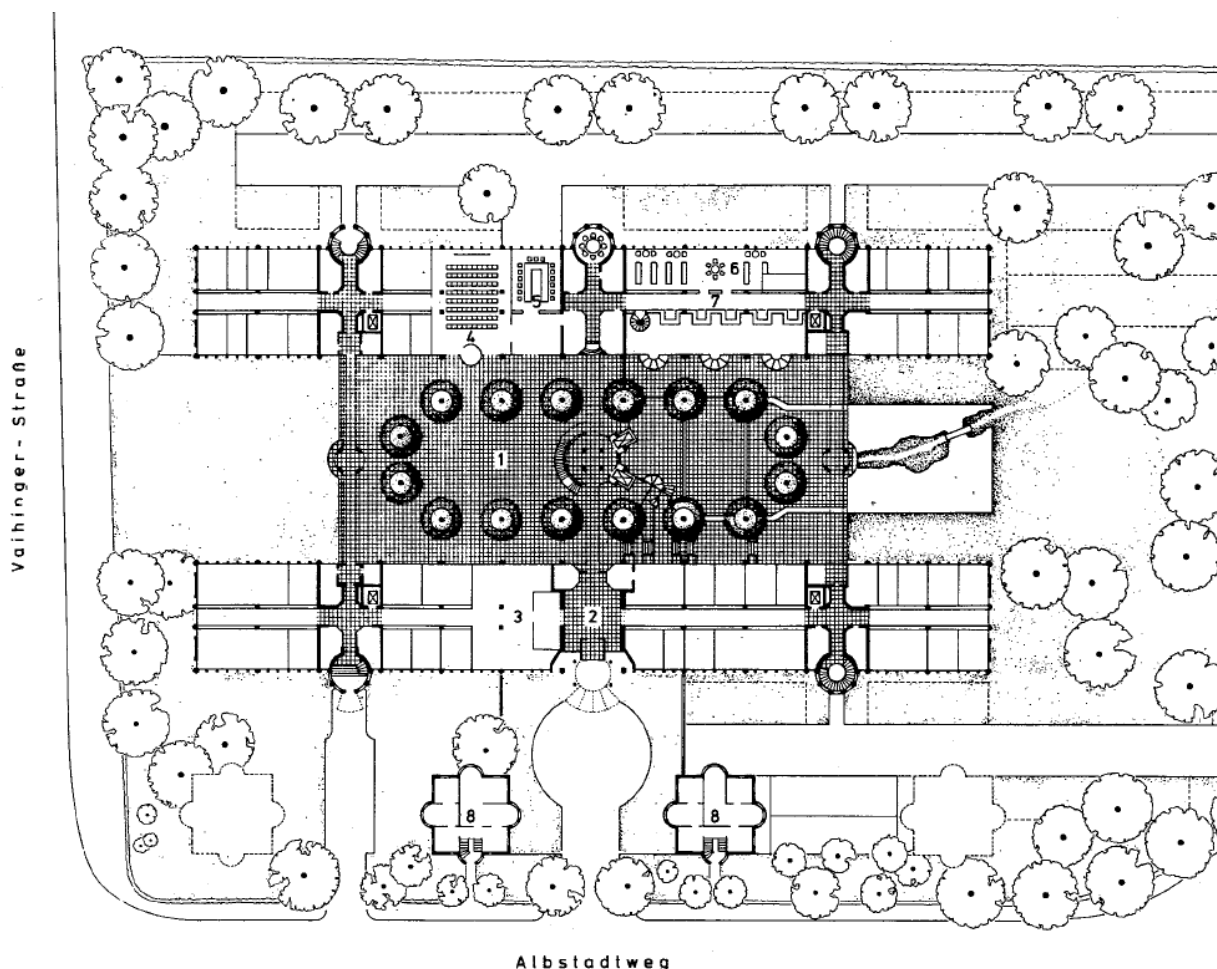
Grundriss Erdgeschoss<sup>1</sup>
